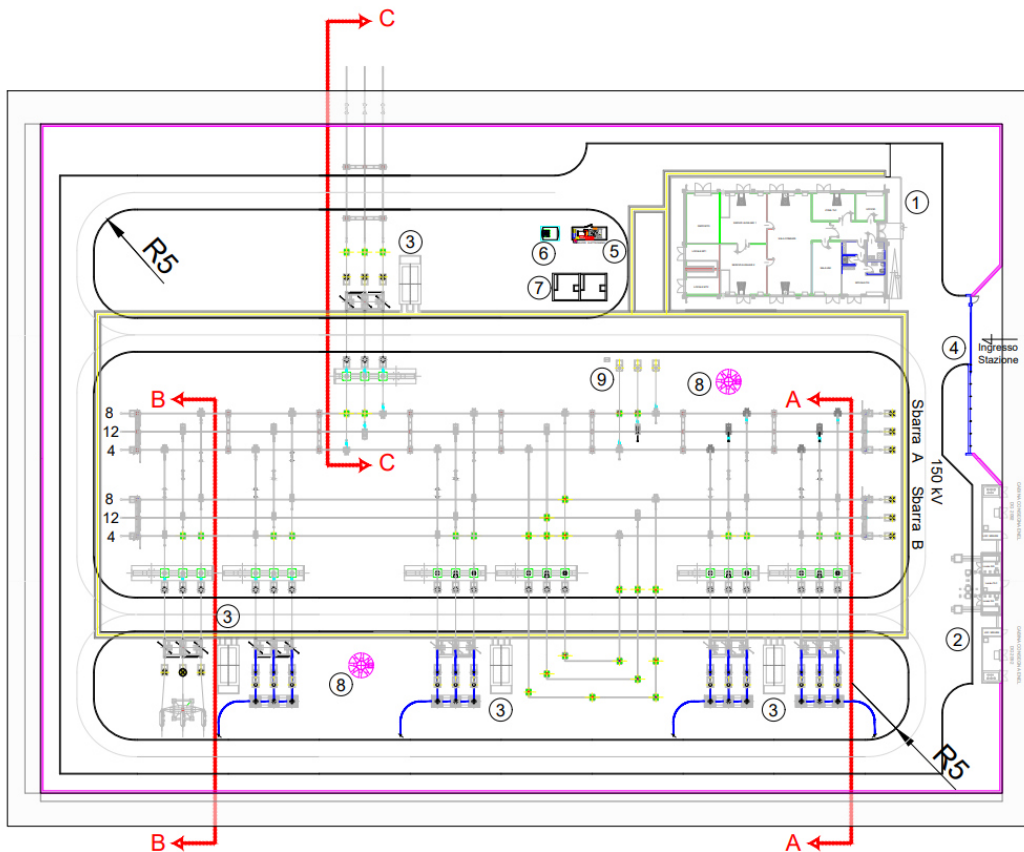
Planimetria nuova Stazione Elettrica di Anagni a 150 kV
